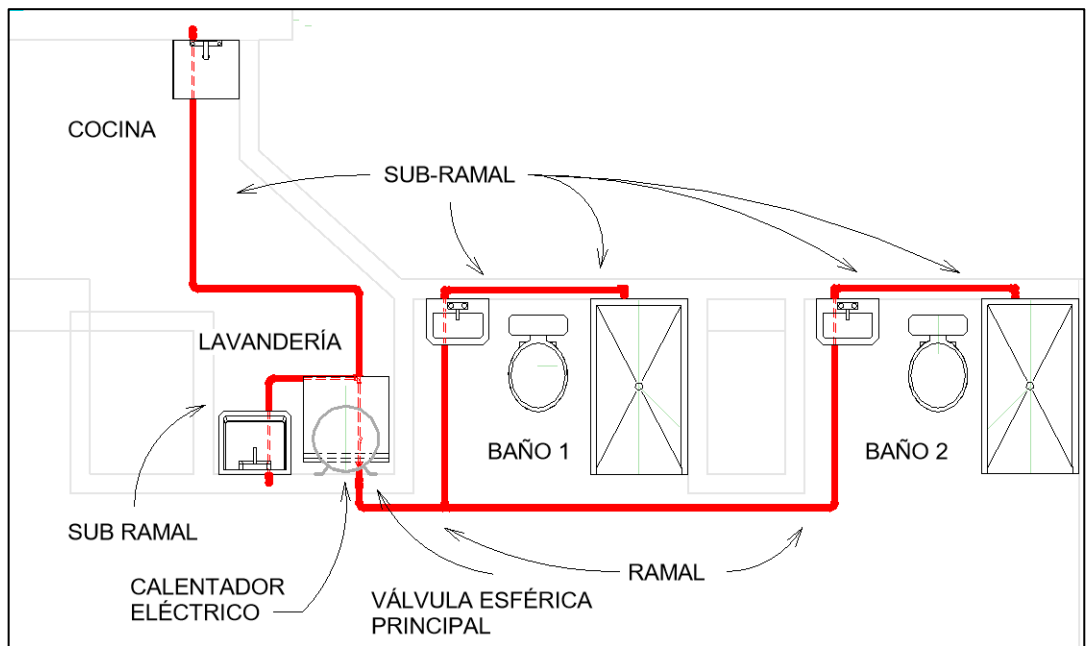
Vista en planta de distribución de agua caliente en departamento.
